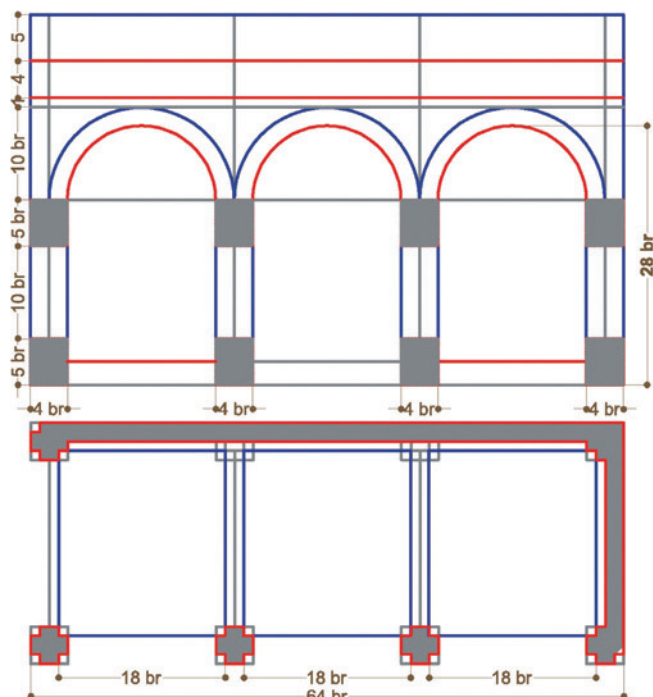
Schéma 4 du plan et de la façade de la Loggia
